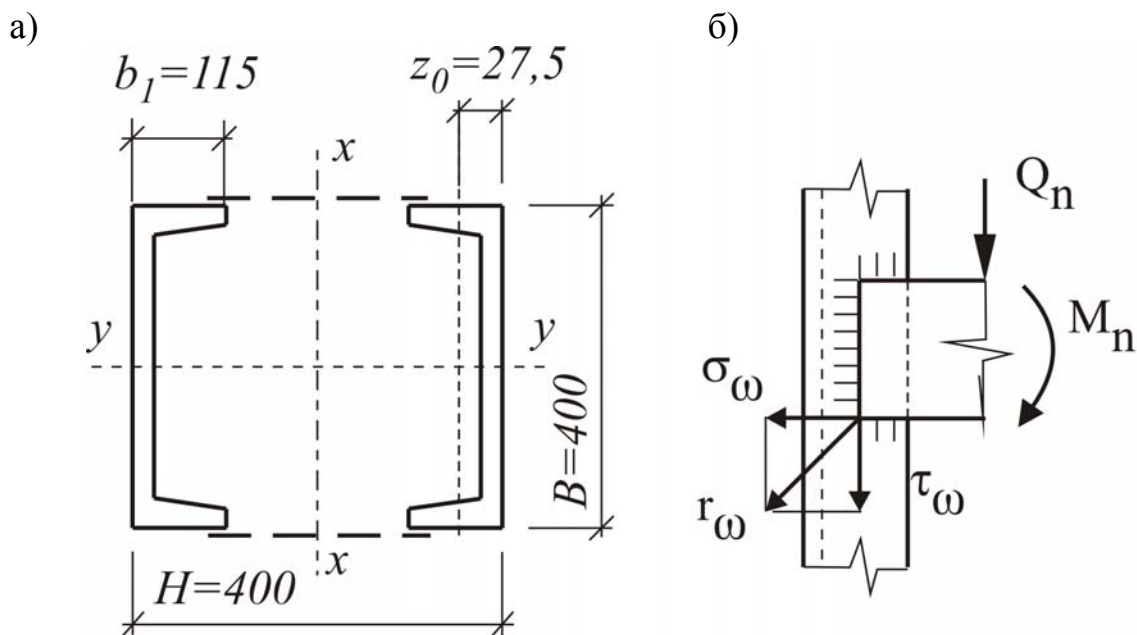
Схема перерізу стійки: а – наскрізного перерізу стійки; б – розрахункова схема кріплення полочки
